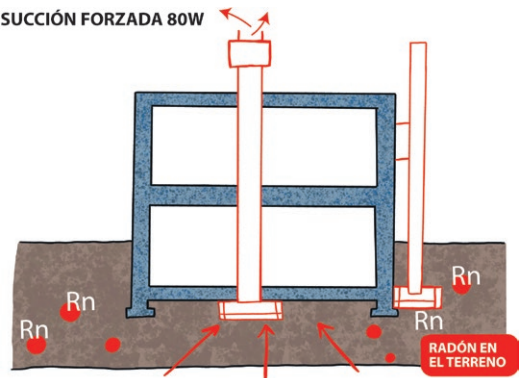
Esquema sistema compuesto de captación, conducción y extracción.
